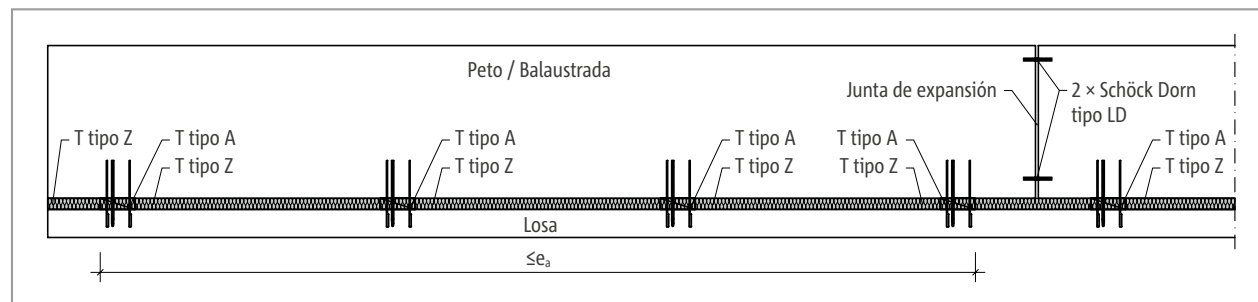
Schöck Isokorb® T tipo A: Disposición de las juntas de expansión
